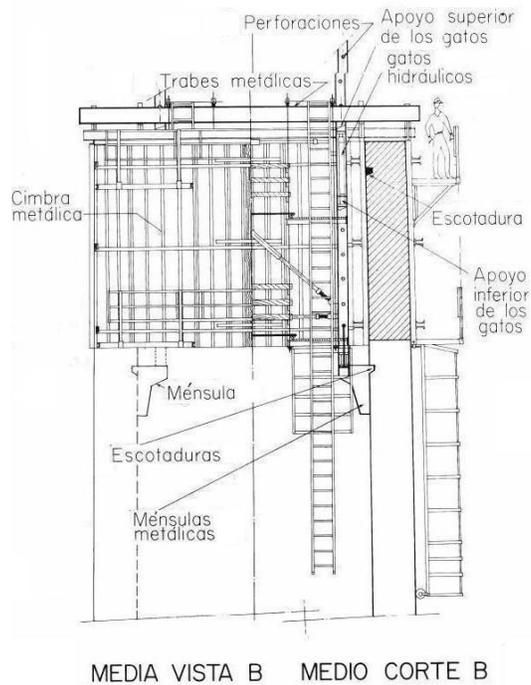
Esquema de la cimbra trepadora utilizada en el puente Metlac, vista del lado B.
